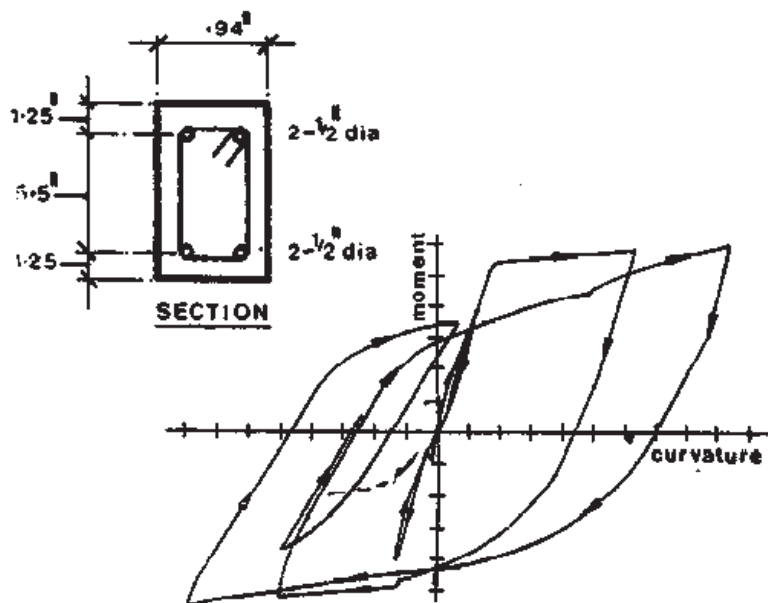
Lazos de histéresis de una viga de concreto reforzado doblemente armada (Park et al., 1975)
